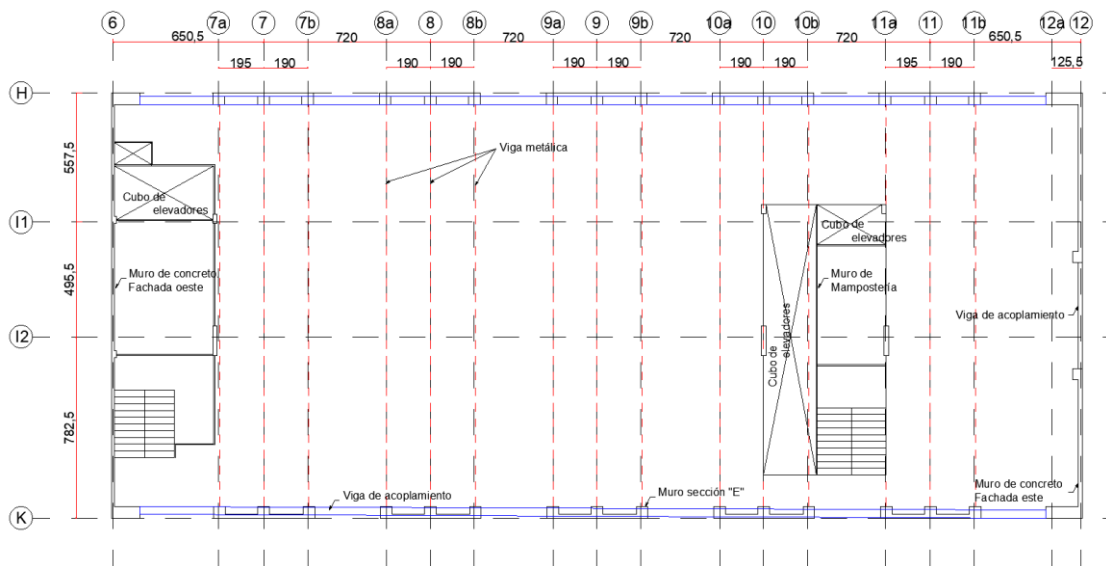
Losa en planta tipo. Principales elementos estructurales y no estructurales (adaptado de SER, 1963).
